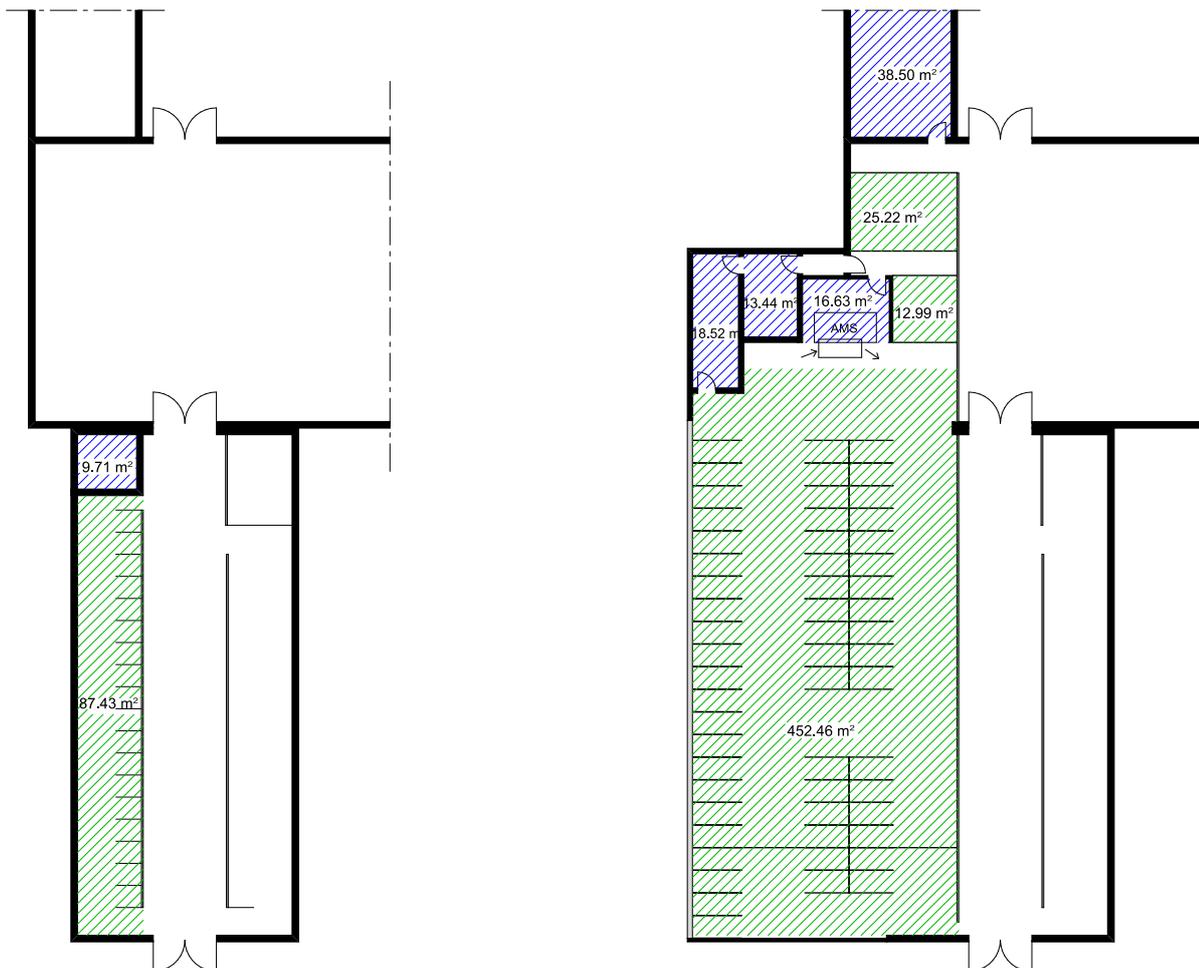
Netto-Grundflächen Betrieb E vor (links) und nach (rechts) dem Umbau, blau schraffiert = Milchkammer/Technik/Nebenräume und Melken, grün schraffiert = Stallbereich Milchkühe
